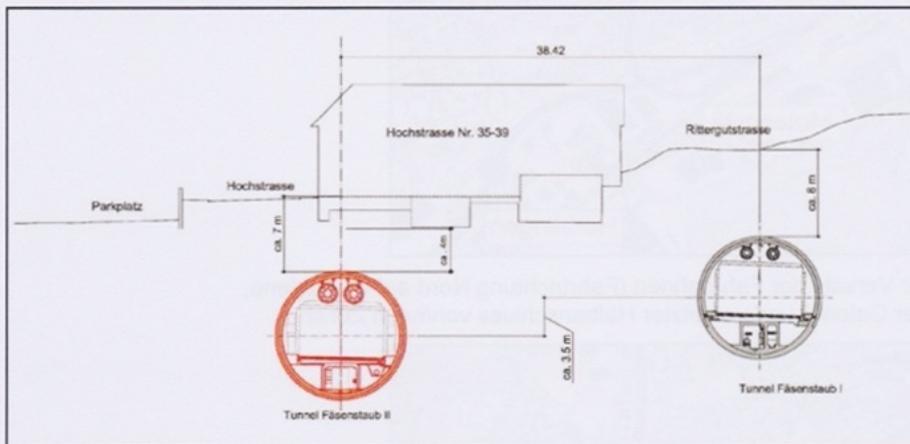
gewählte Tieferlegung des Tunnels Fäsenstaub II (rot) im Vergleich zum bestehenden Tunnel (Variante 2)
